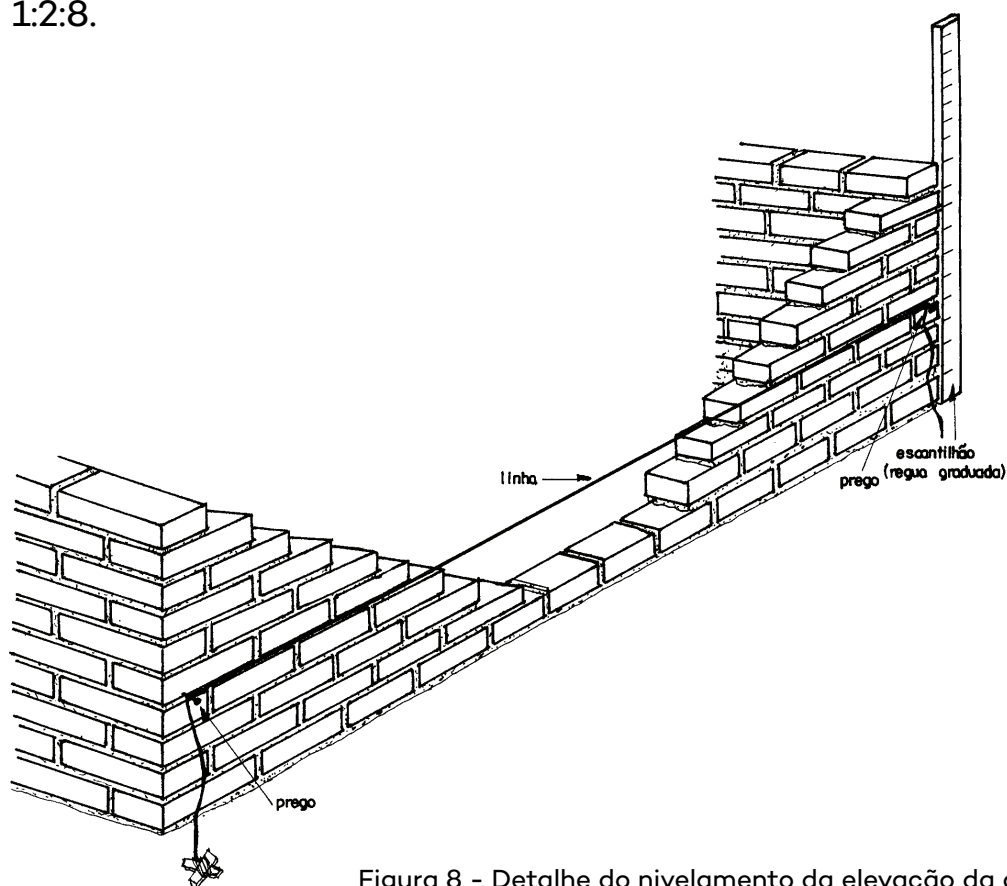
Detalhe do nivelamento da elevação da alvenaria
